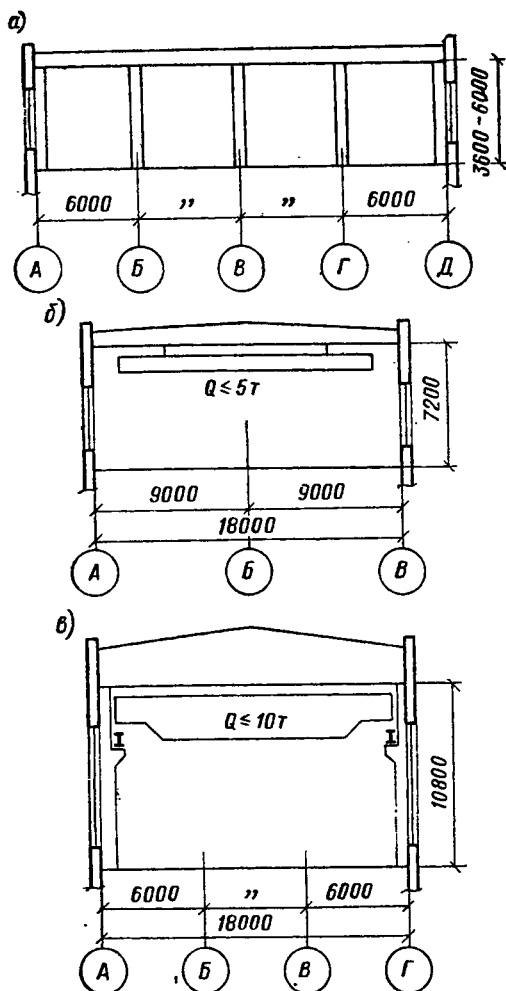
Варианты верхнего этажа многоэтажных зданий по серии ИИ20/70
